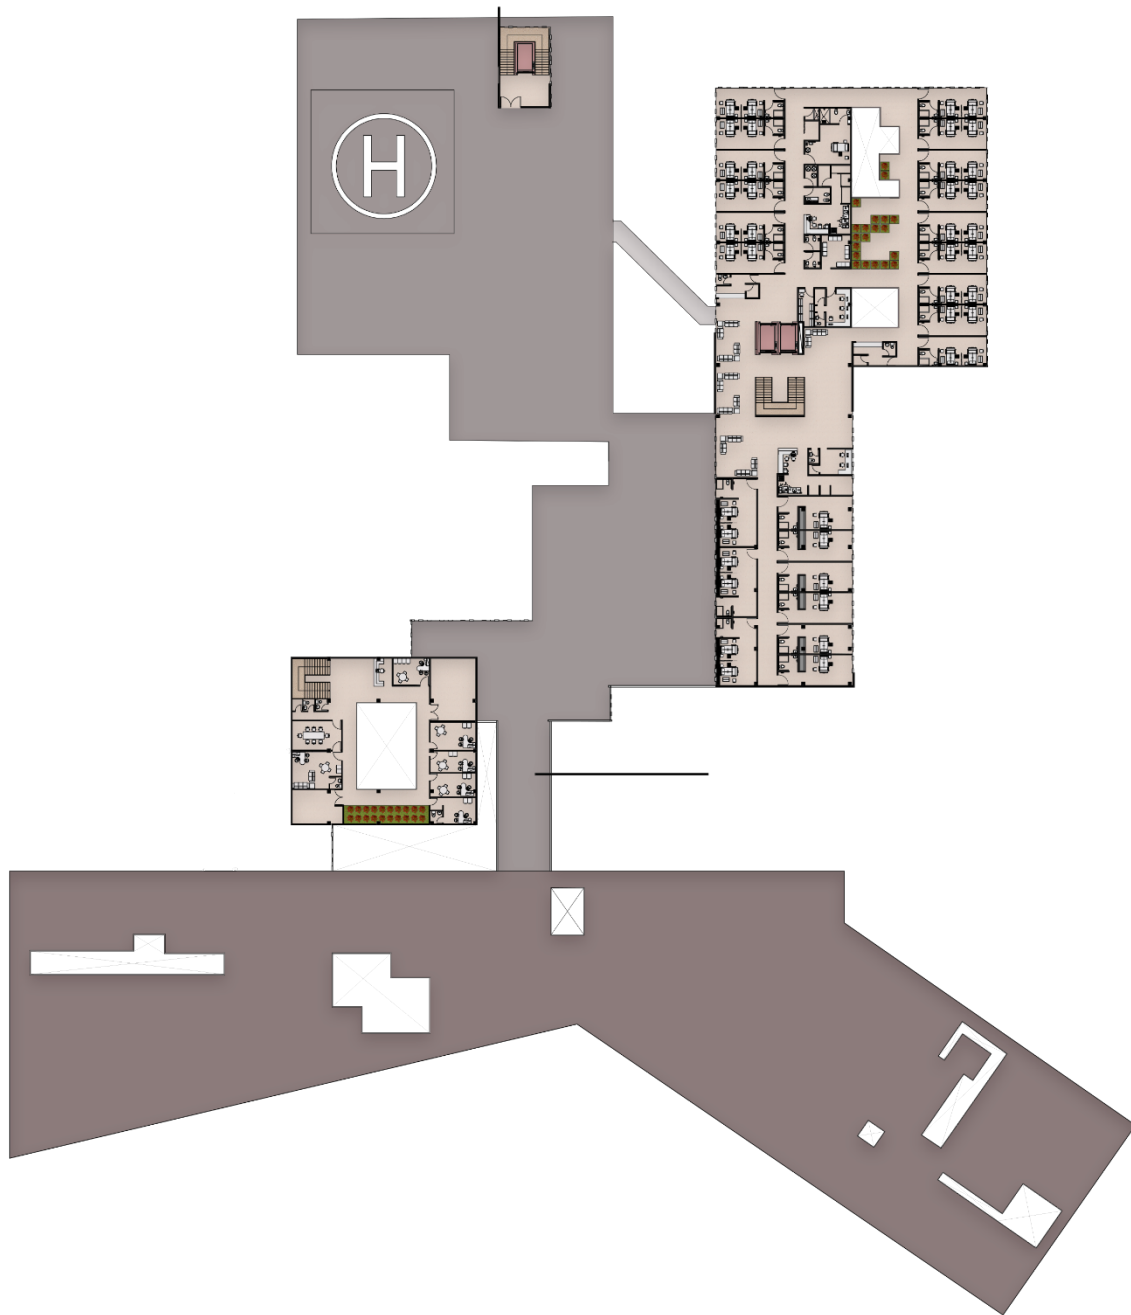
Planta 4to Piso. Nota: Distribución de la cuarta planta. Elaboración propia: Photoshop
